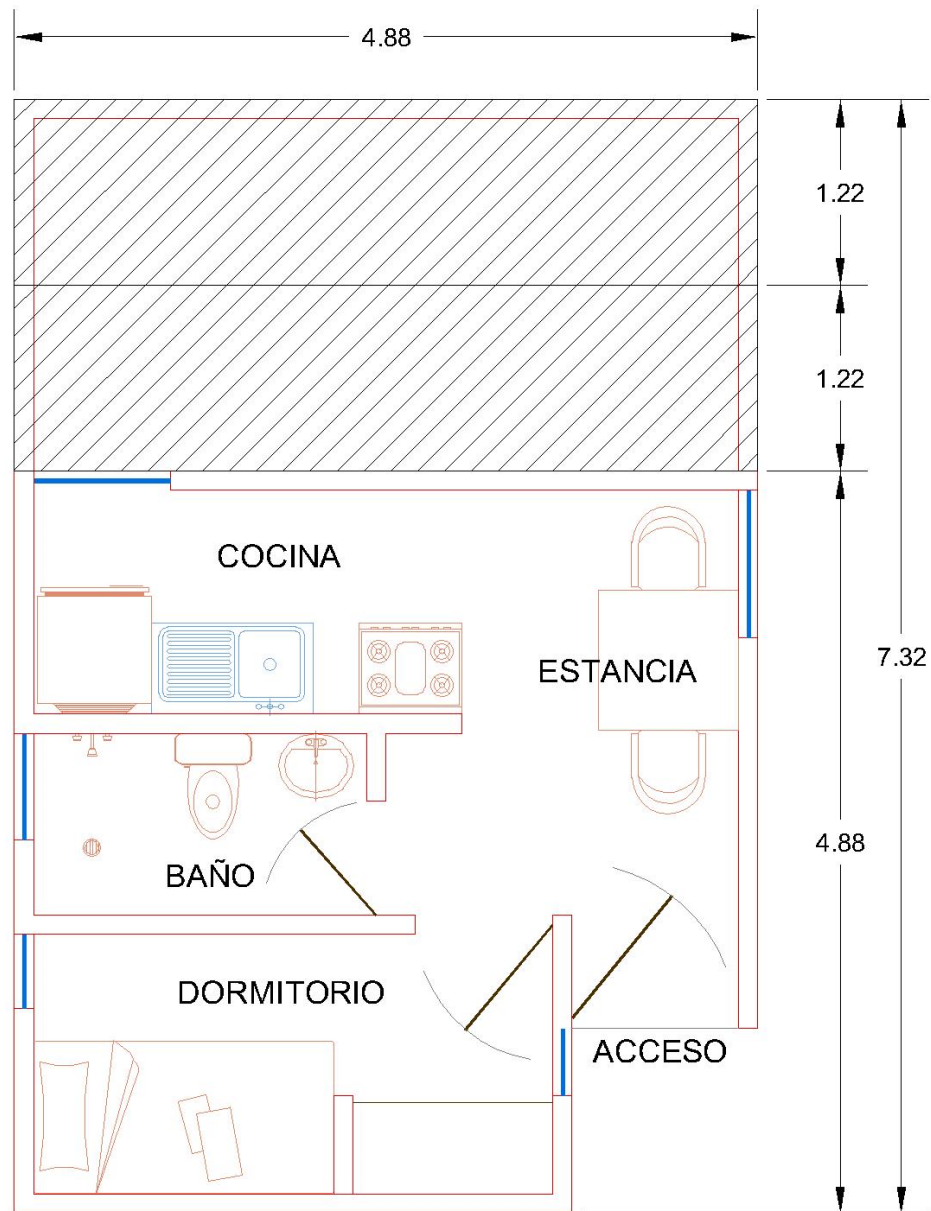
Ampliación de vivienda básica utilizando modulo "A" en Planta Arquitectónica de vivienda básica (esquema elaborado por el autor)
